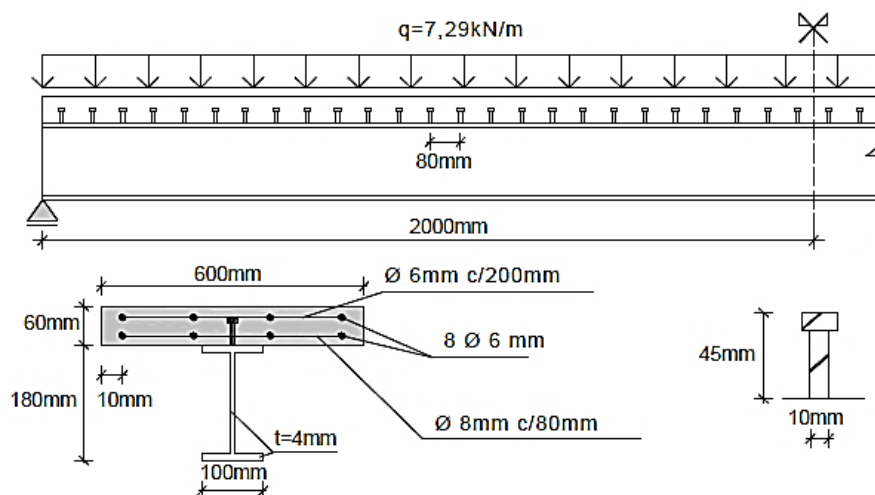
Vigas LCB1 e LCB2 – características geométricas e carregamento – Fonte: Moreno (2016).
